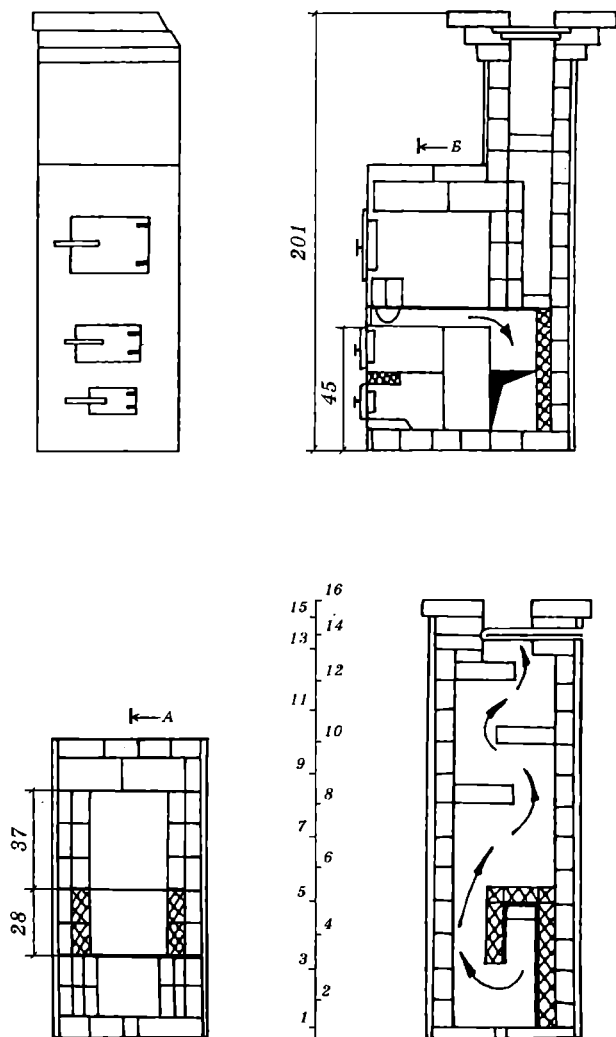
Печь-каменка конструкции А. Ф. Филичко
